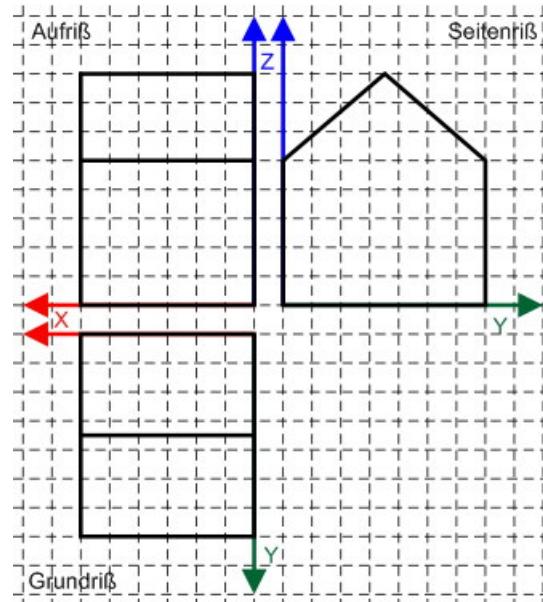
Grund-, Auf- und Seitenriss eines Hauses
